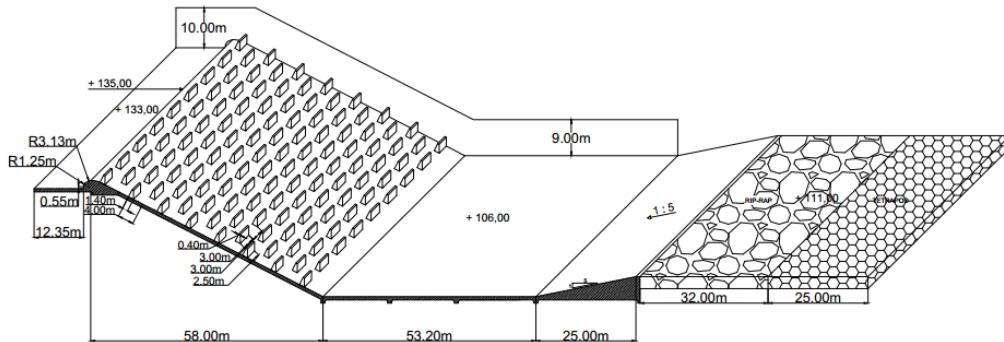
Denah Saluran, Kolam Olak, dan *Escape Channel Seri I
